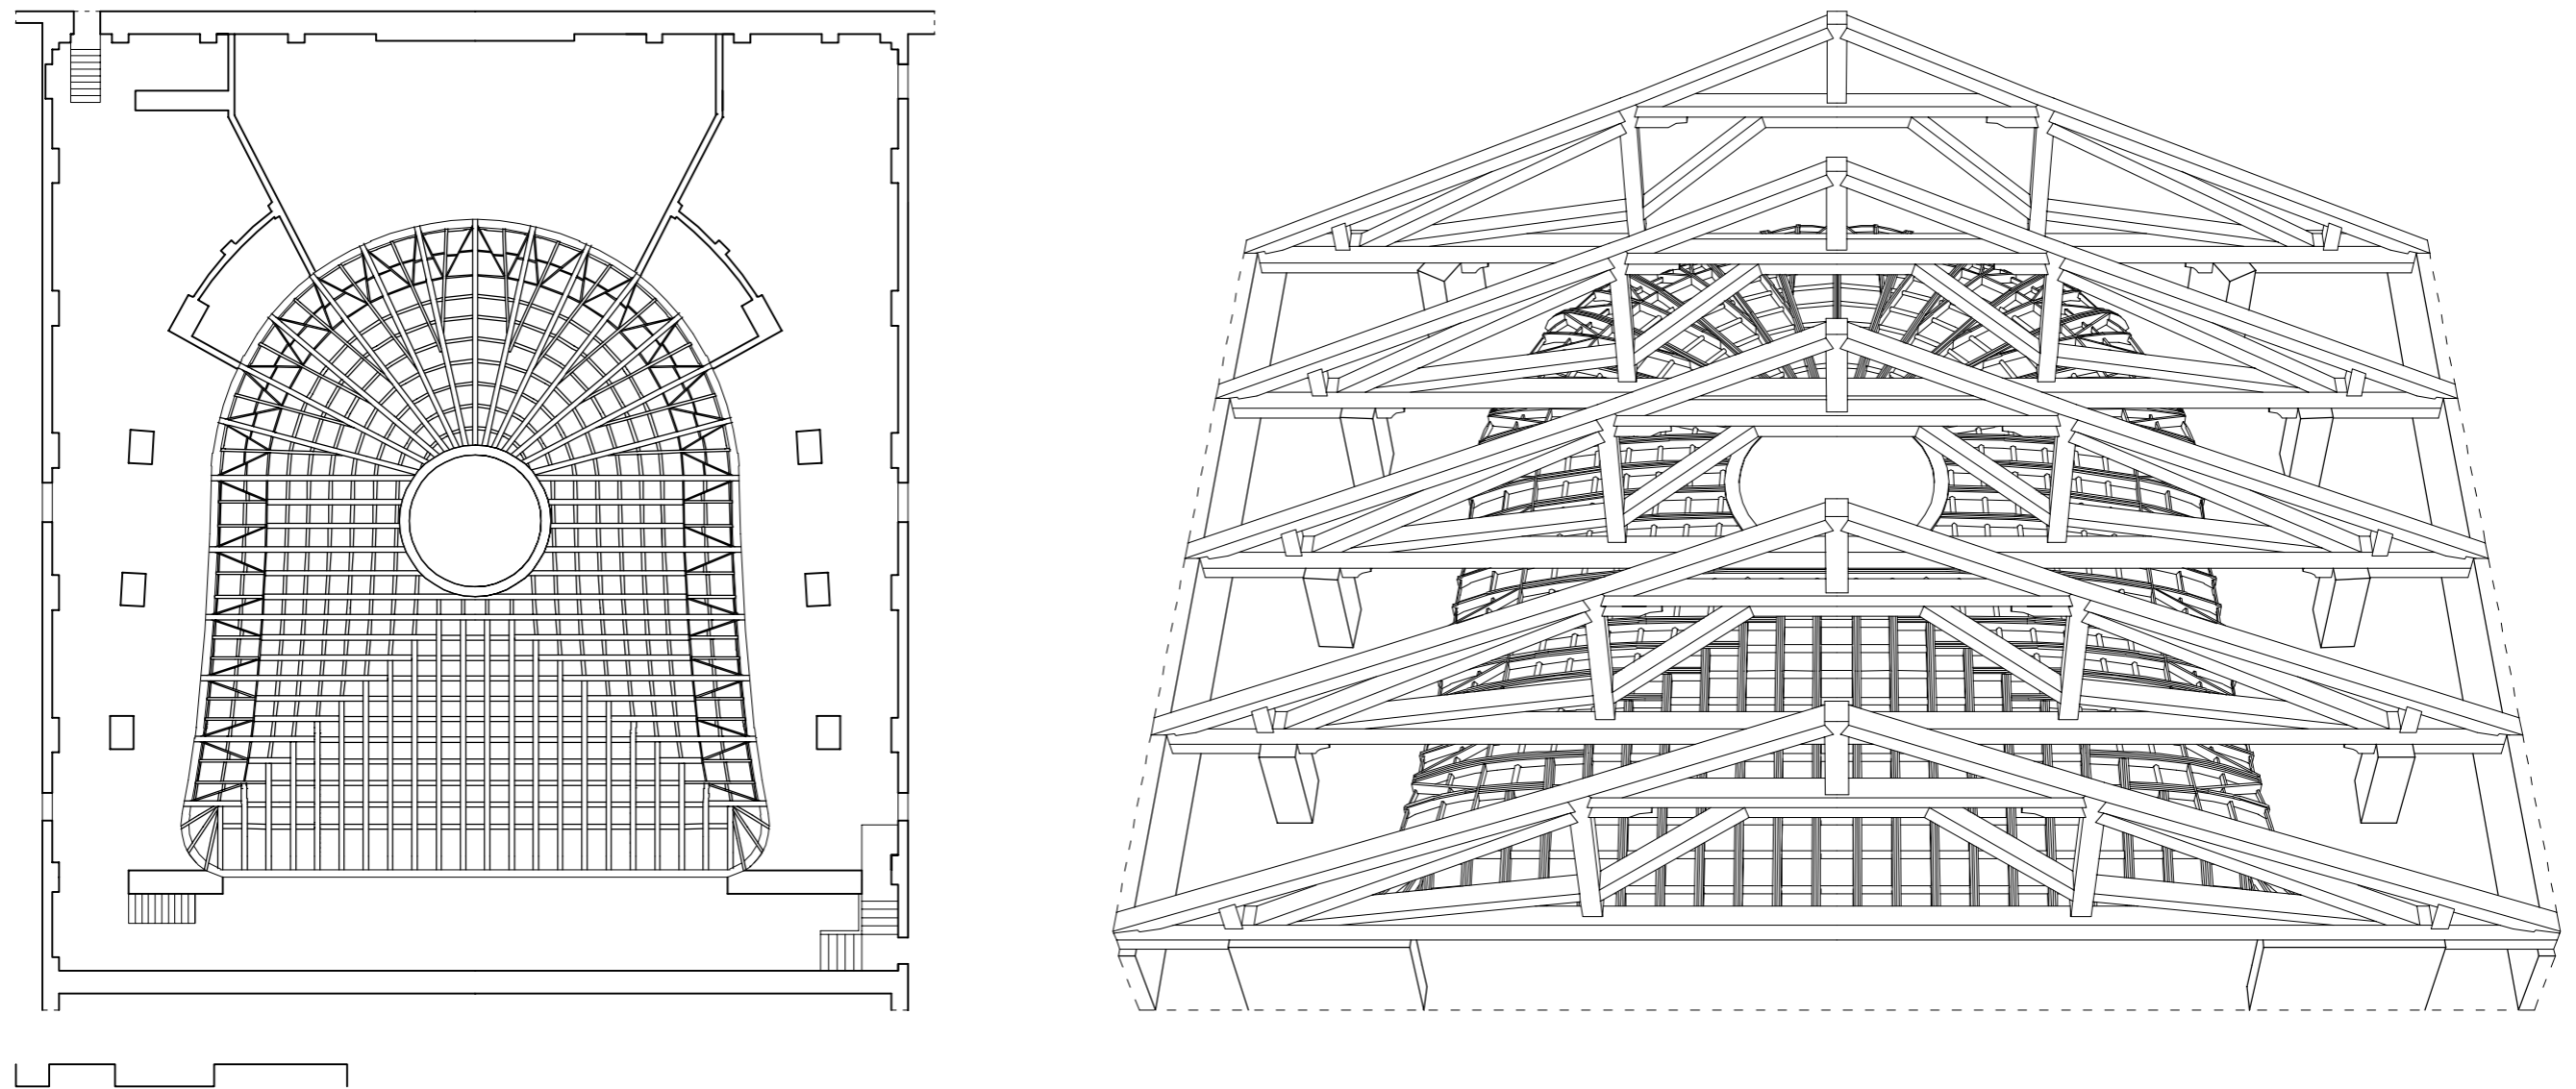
Teatro Comunale di Bologna. Pianta del piano sottotetto (ridisegno); rappresentazione prospettica del sistema di copertura della sala.
